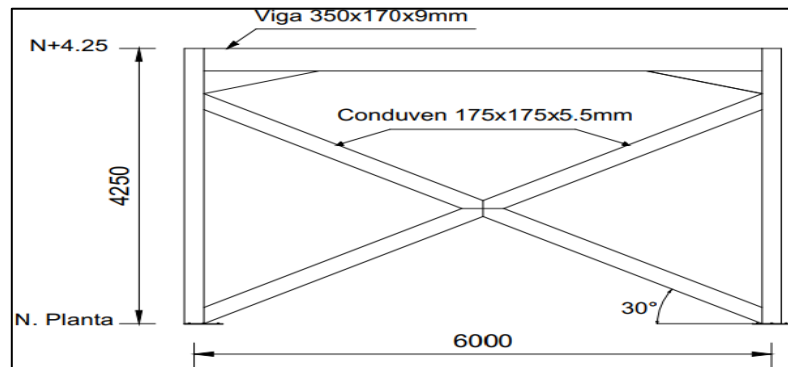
Pórtico entre N. planta y N+4.25, con arriostamiento lateral en "X", viga 350x170x9mm, y luz de 6.00m
